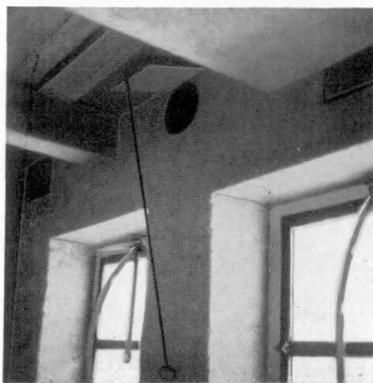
Verschlussklappe eines Entlüftungsrohres unter der Stalldecke mit eiserner Stellstange.
